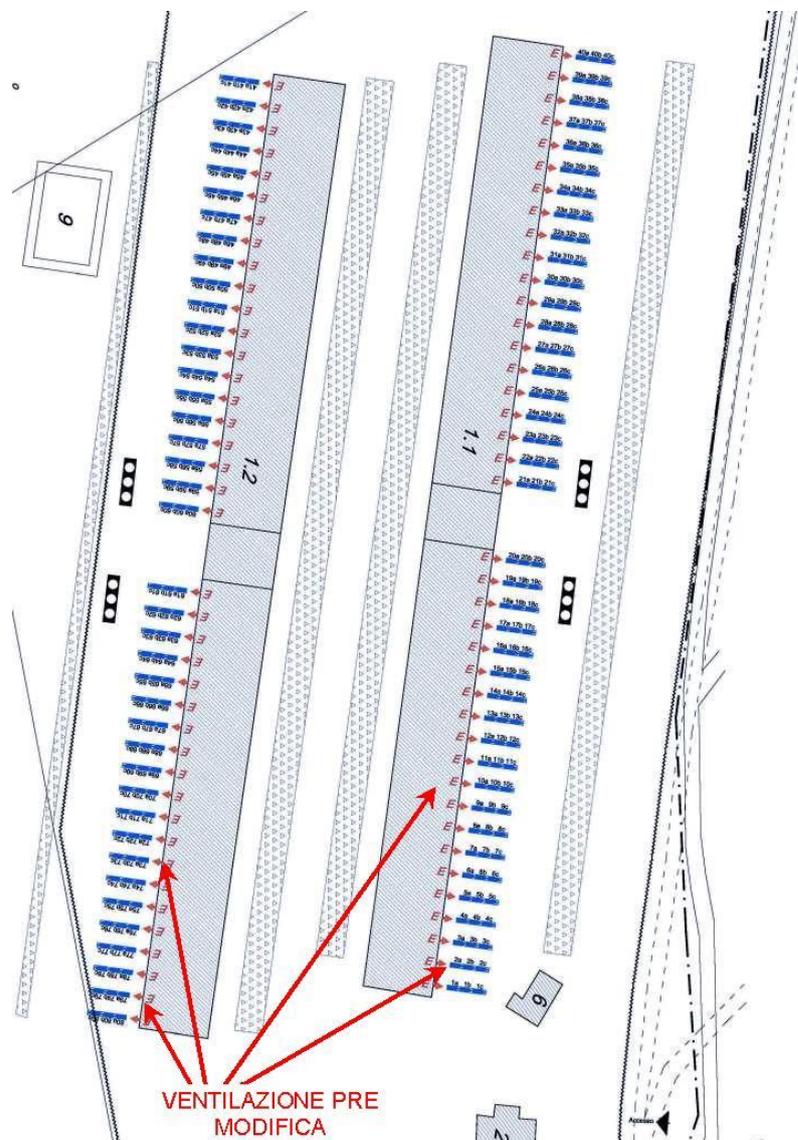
Planimetria Ventilazione pre modifica - MORRO D'ORO.
